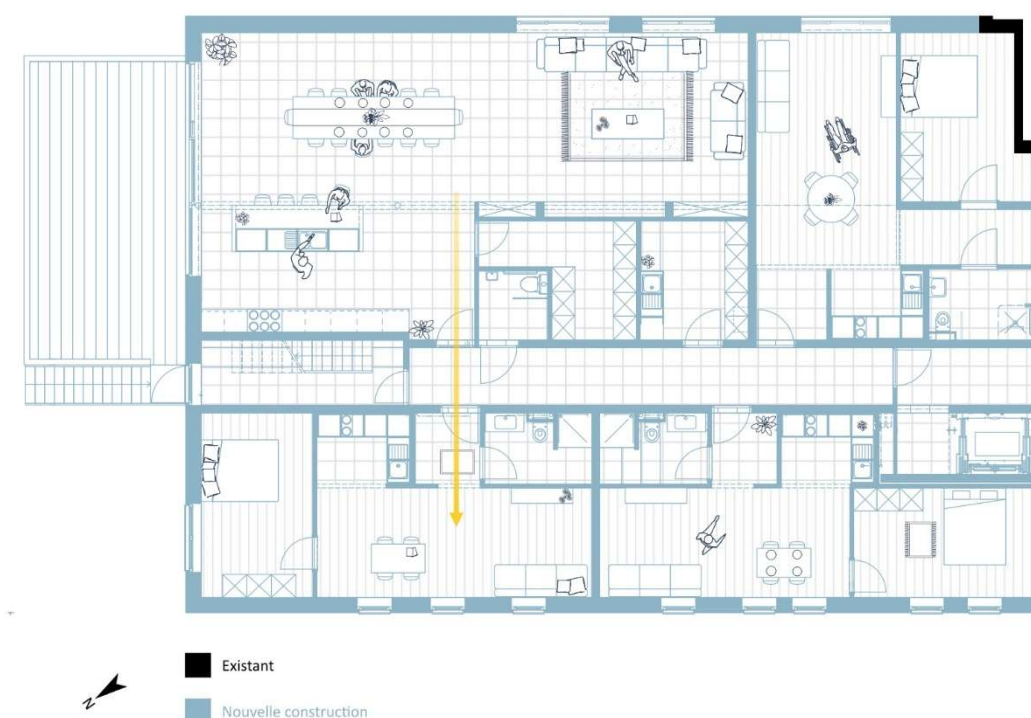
Plan du rez-de-chaussée - Maison l'Eau Vive
